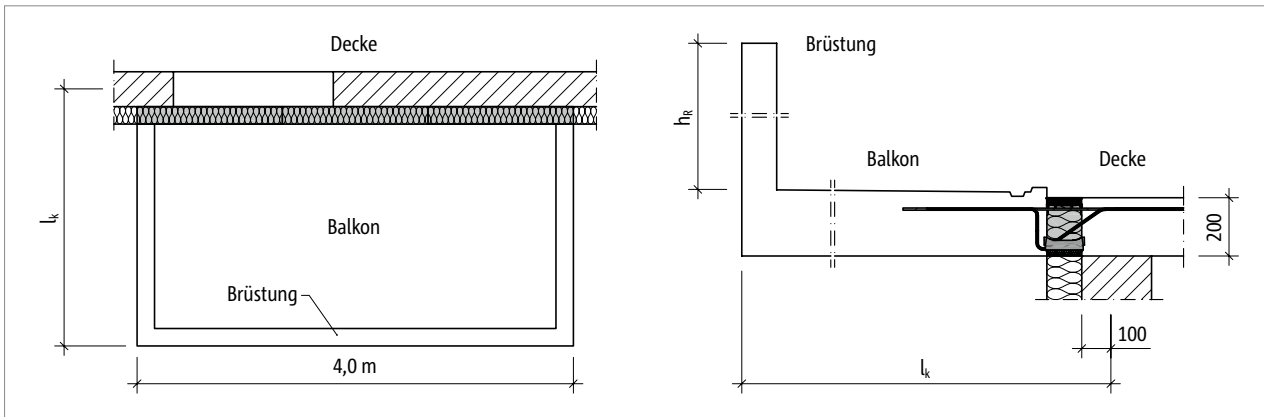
Ausragender Beispielbalkon, Grundriss und statisches System
